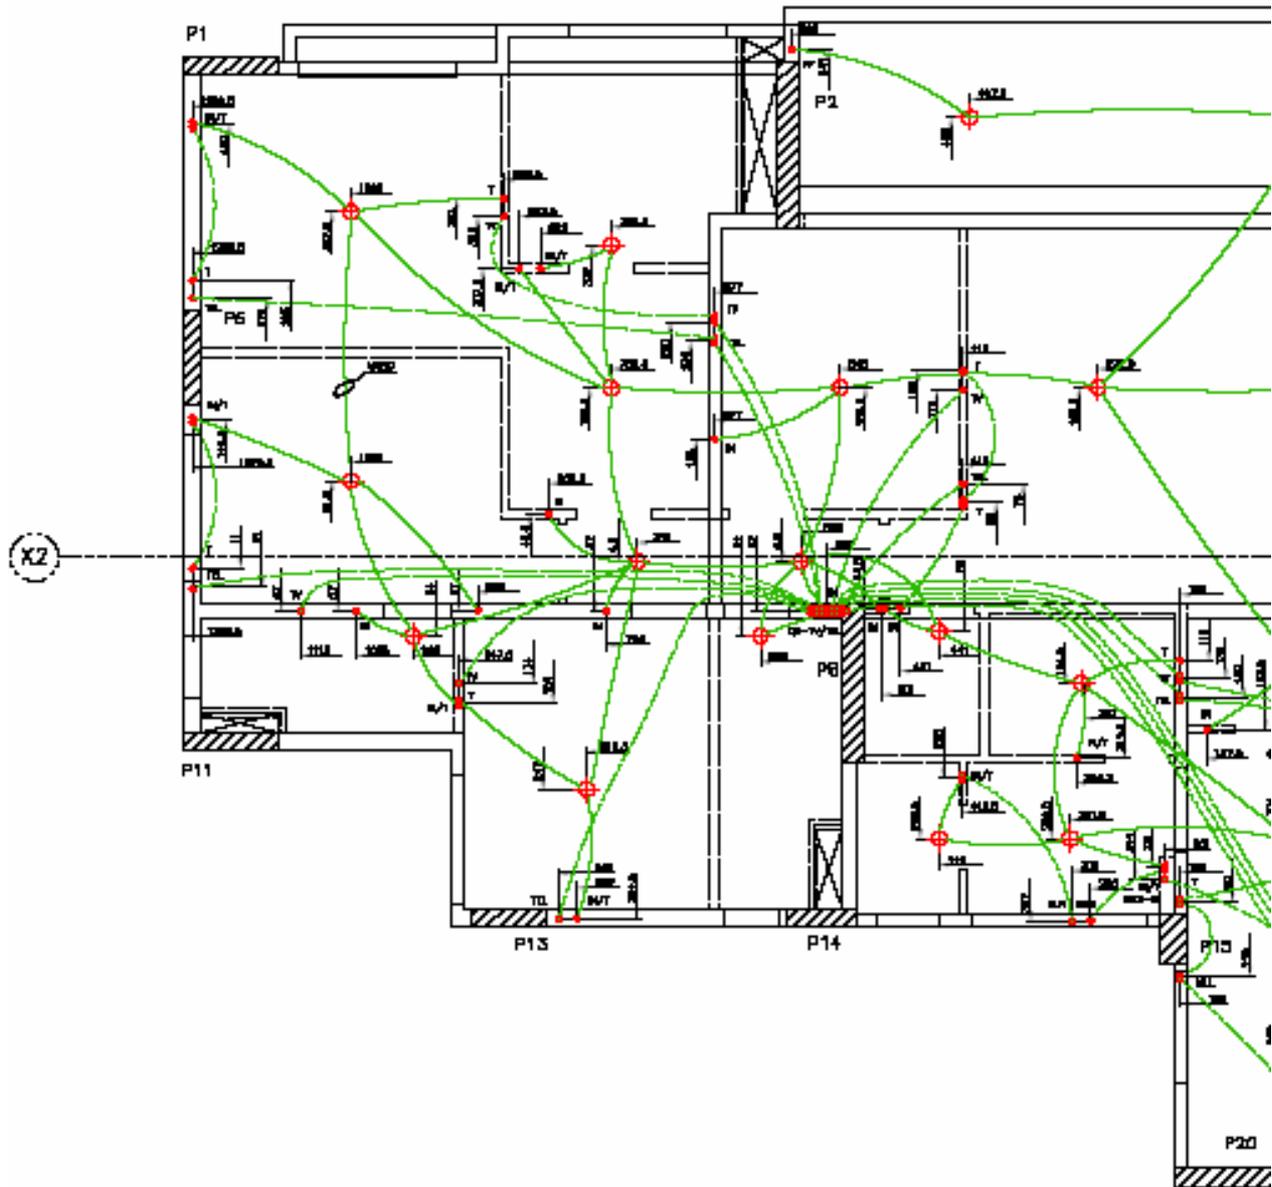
Exemplo de planta de locação de pontos elétricos de um PPVVA
